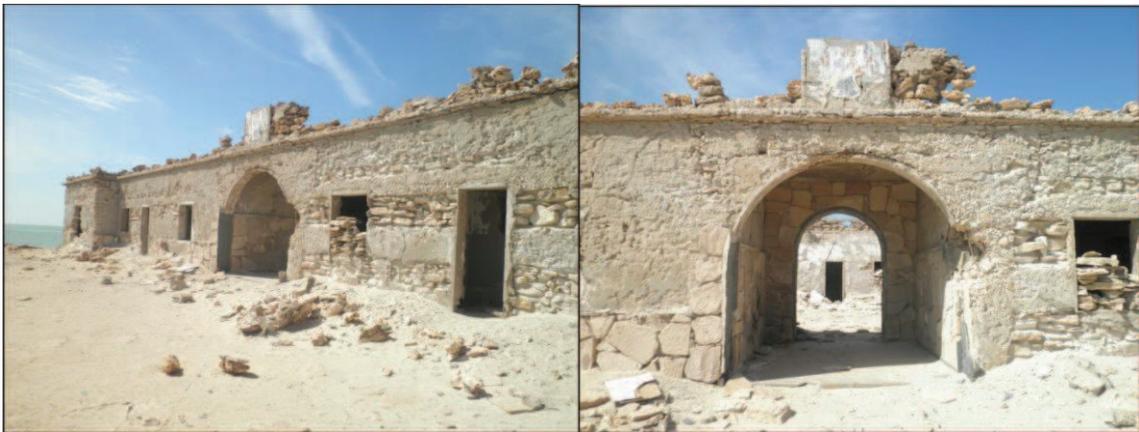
Vista exterior de la fachada principal en el lado sureste (2013)
